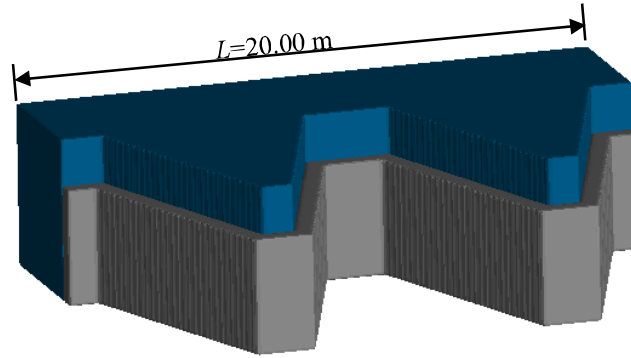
Trapez labirent savakların plan üzerinde gösterimi
